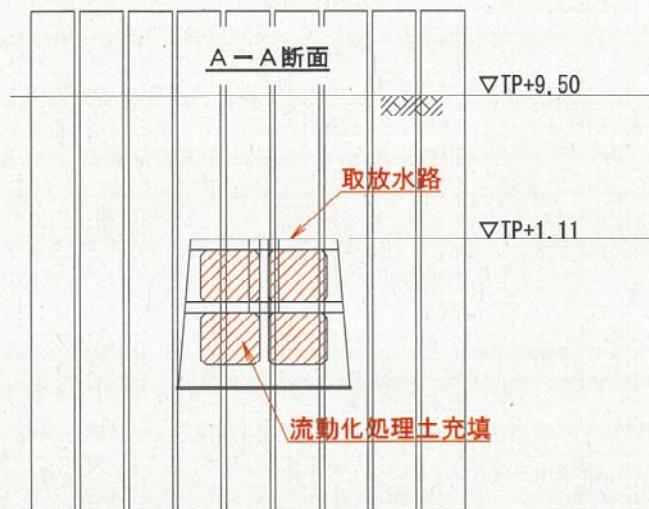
取放水路埋戻し位置断面図 (A-A断面)
